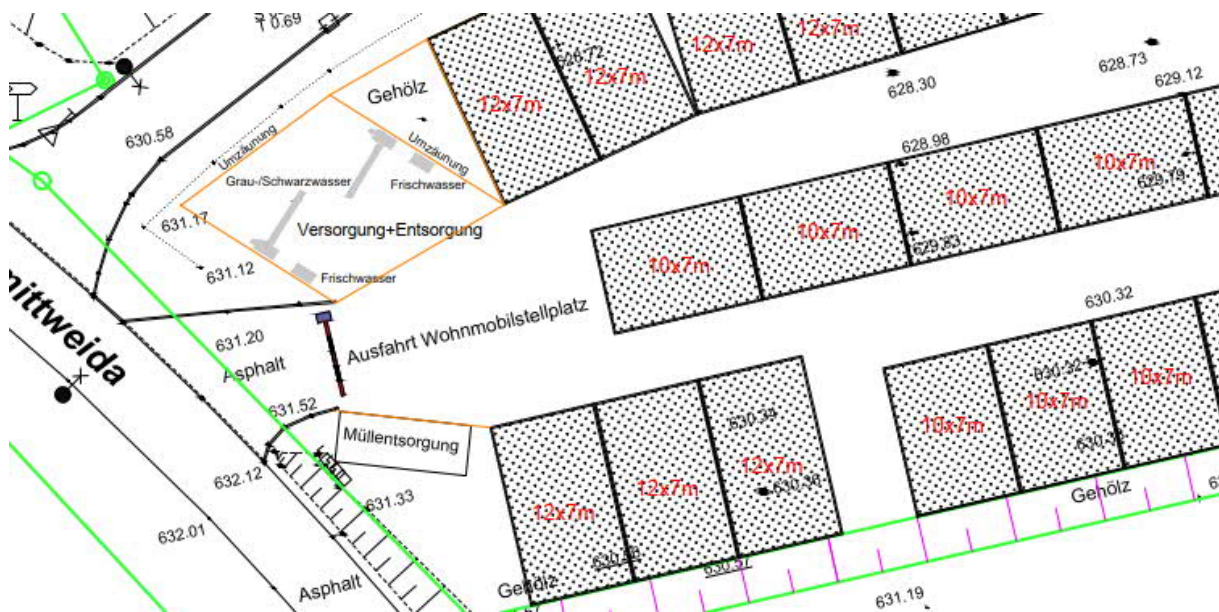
Auszug aus Vermessungsplan mit Wohnmobil-Stellplatzplanung mit Nebenanlagen ⁶⁴
